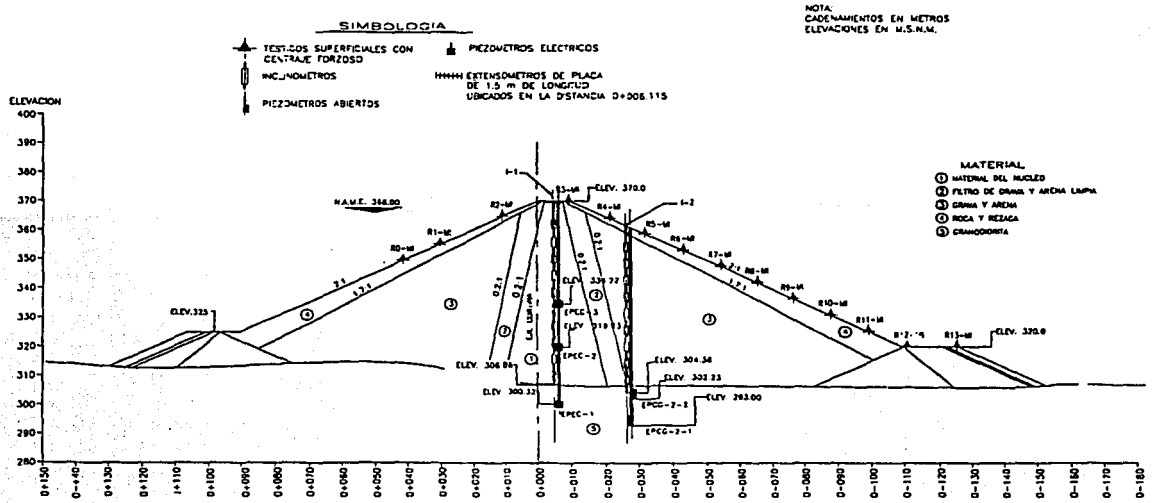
Instrumentación. Sección transversal cadenamiento 0+130.
